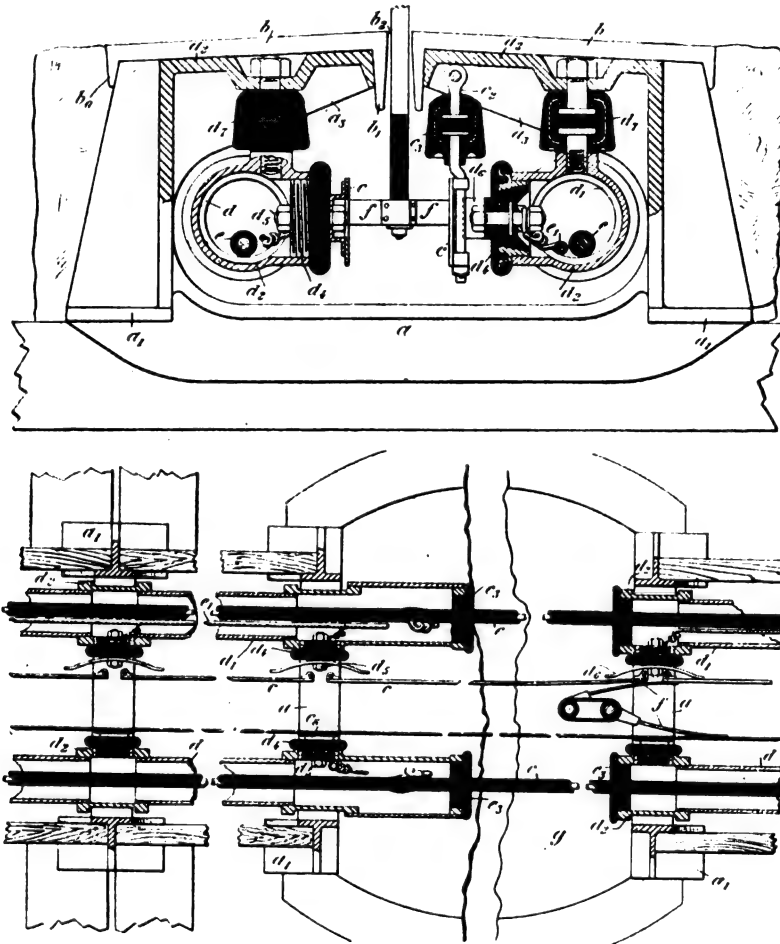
et 46. — Caniveau Krotz, Allen, Kelly. Coupe transversale et vue en plan.
